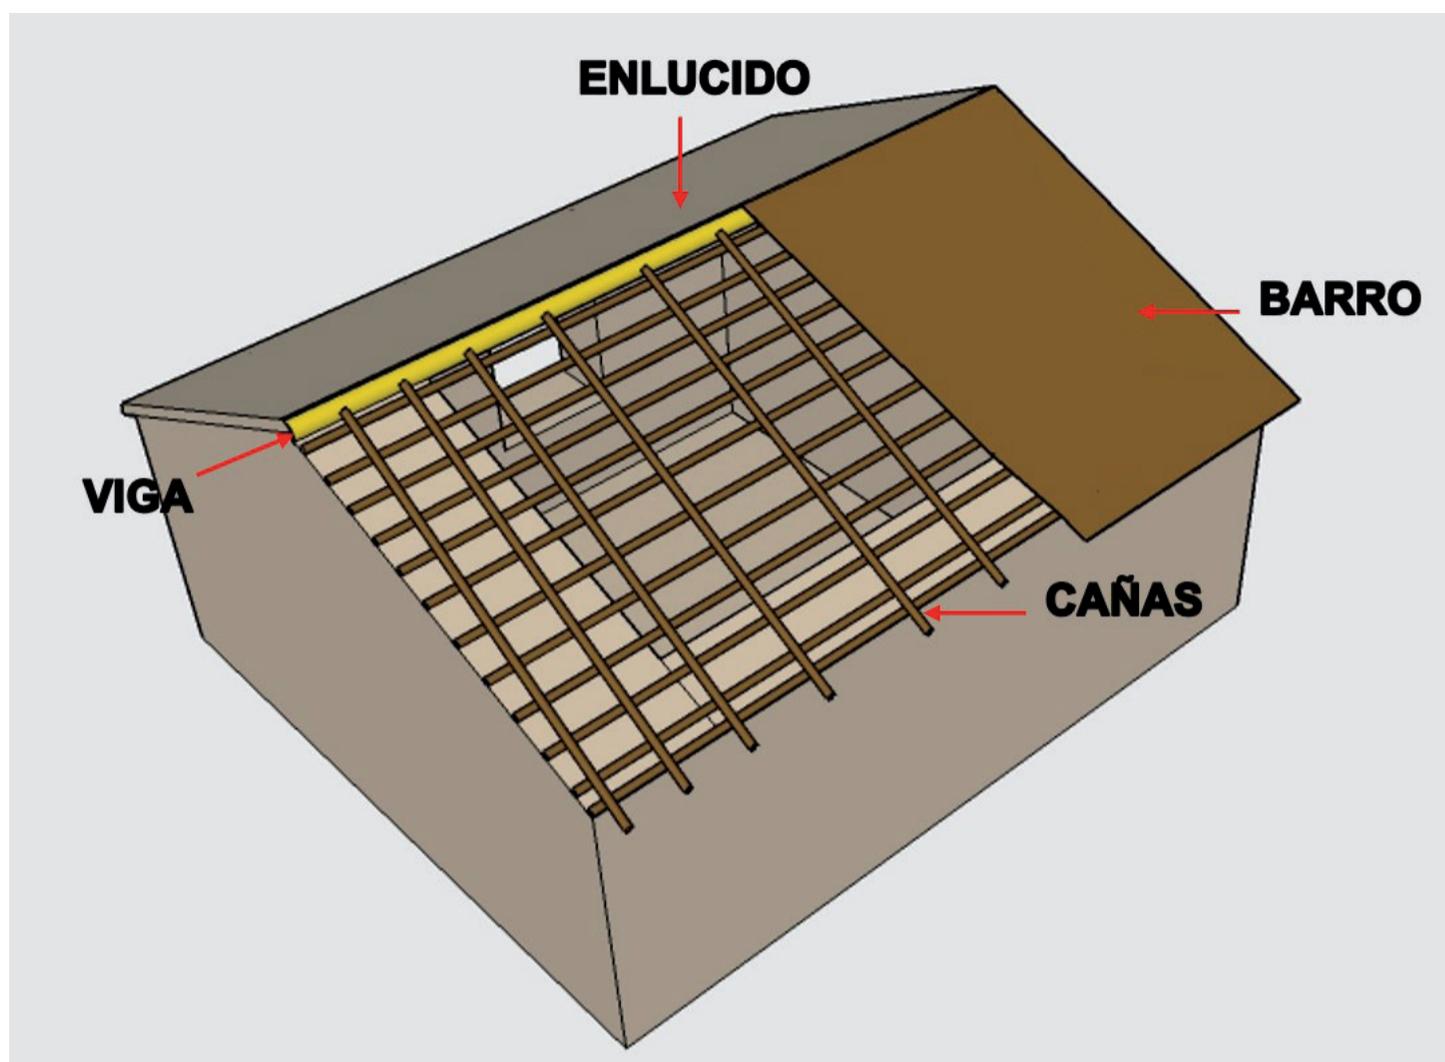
Detalles en la construcción de la cubierta de los depósitos.
